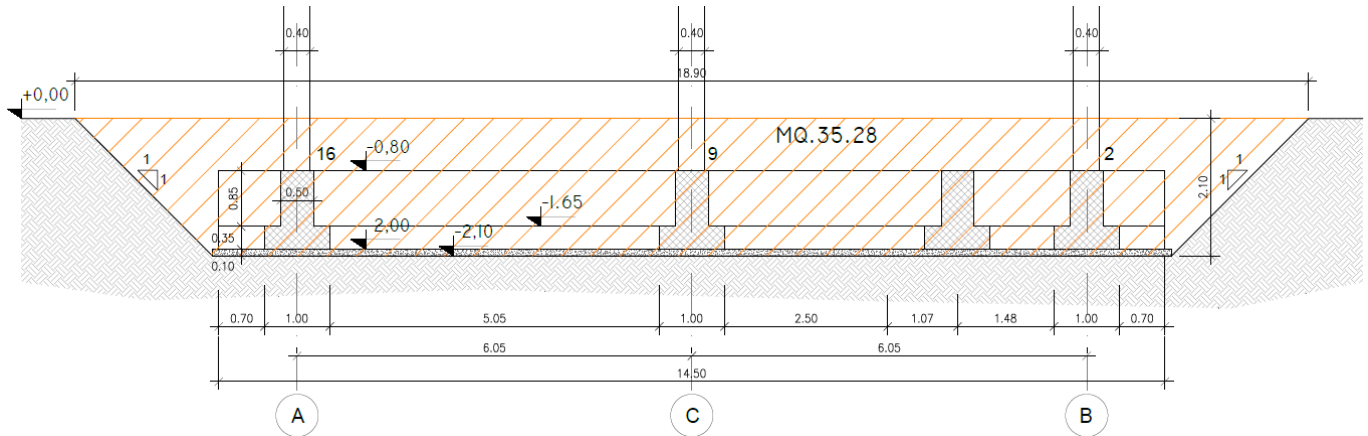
Esempio di sezione trasversale delle fondazioni tipiche per strutture come quella in progetto
